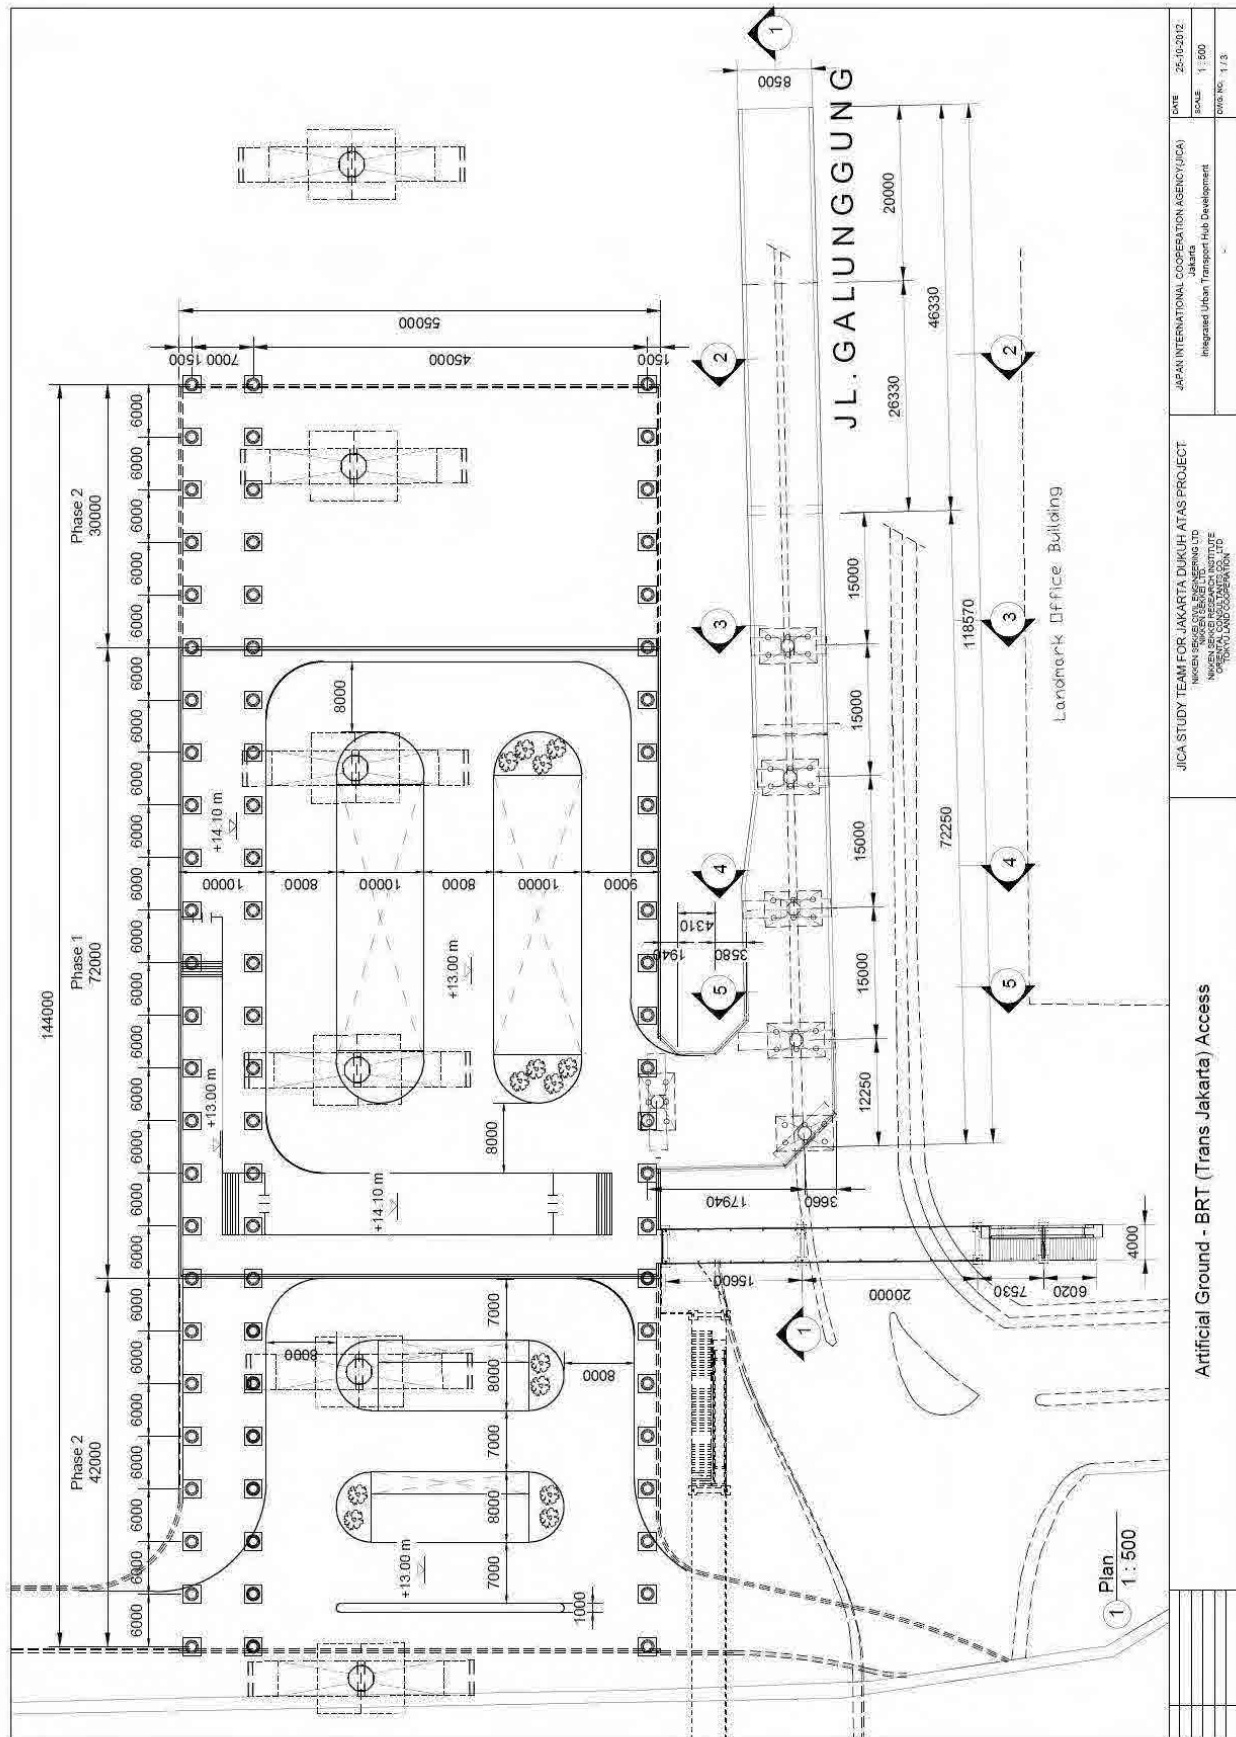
BRT アクセス道路平面図 (出典：調査団)
